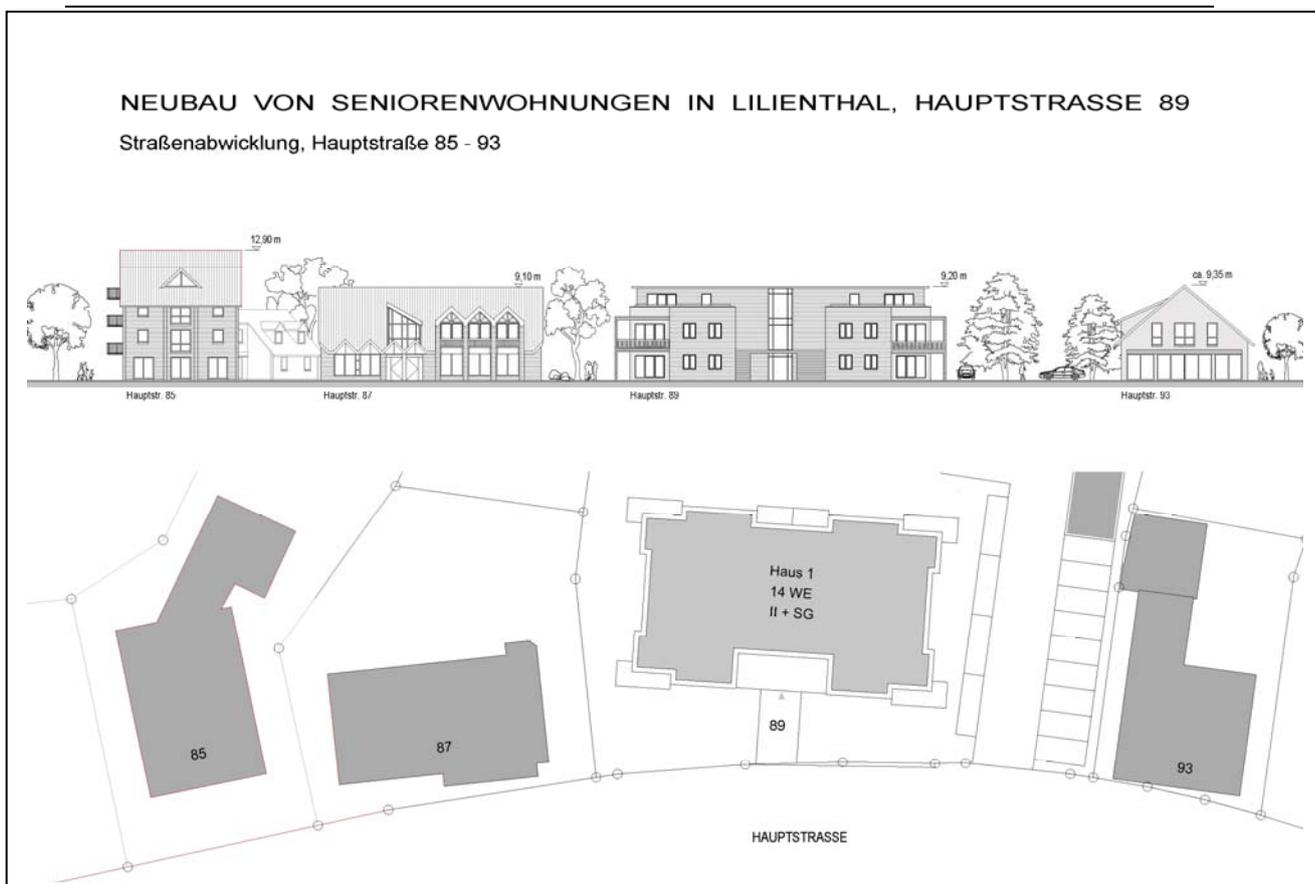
Planungskonzept Hauptstraße 89, Straßenansicht Hauptstraße, PGN 9/2015
